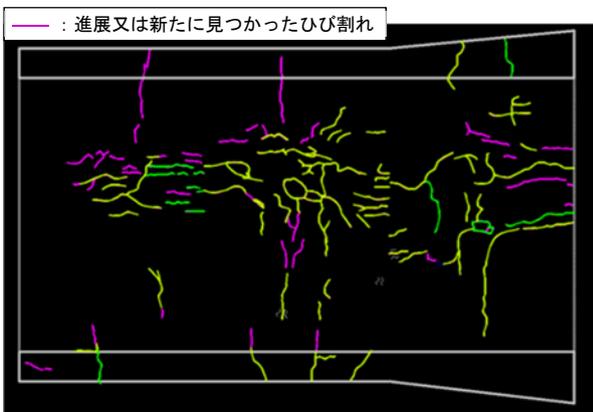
(c) ひび割れの点検時期による変動例(重合せ)
